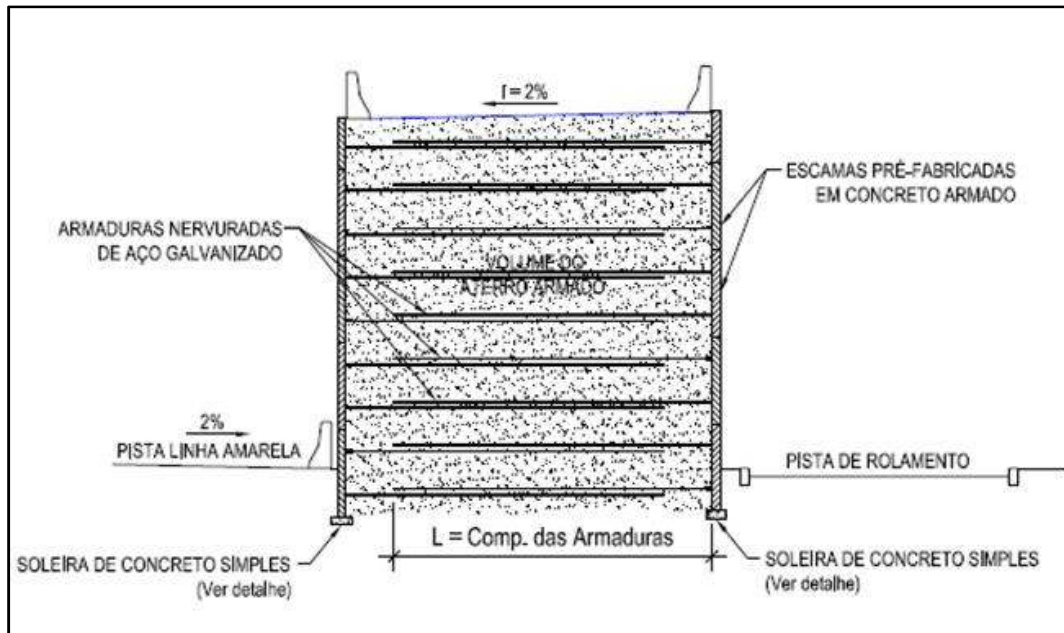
Seção tipo ilustrando as camadas de aterro divididas com armaduras nervuradas de aço galvanizado
